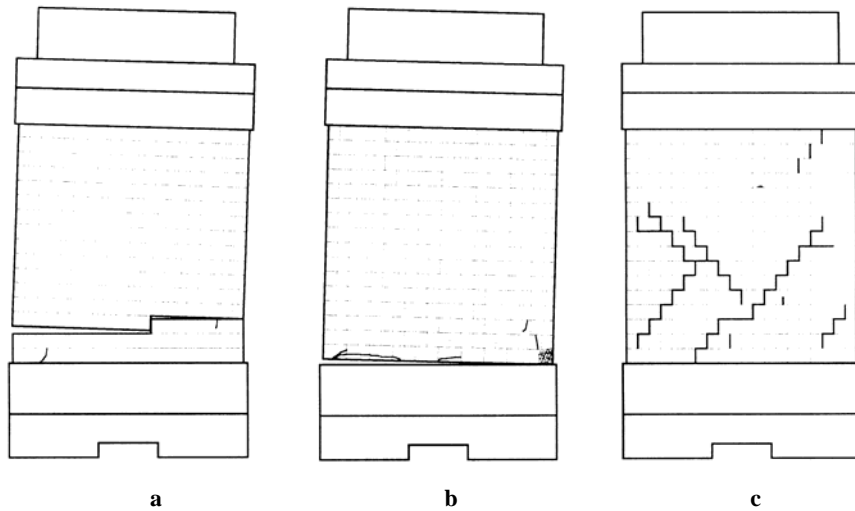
64 — Fisuras y fracturas observadas durante la parte final de los ensayos de los paneles de intacto (a), reforzado con fibra de vidrio (b) y reforzado con fibra de carbono (c); (Badoux et al., 2002).
